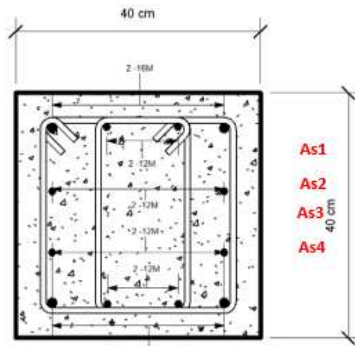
Armado de refuerzo de la columna (SMF) del sistema de 6 Pisos
